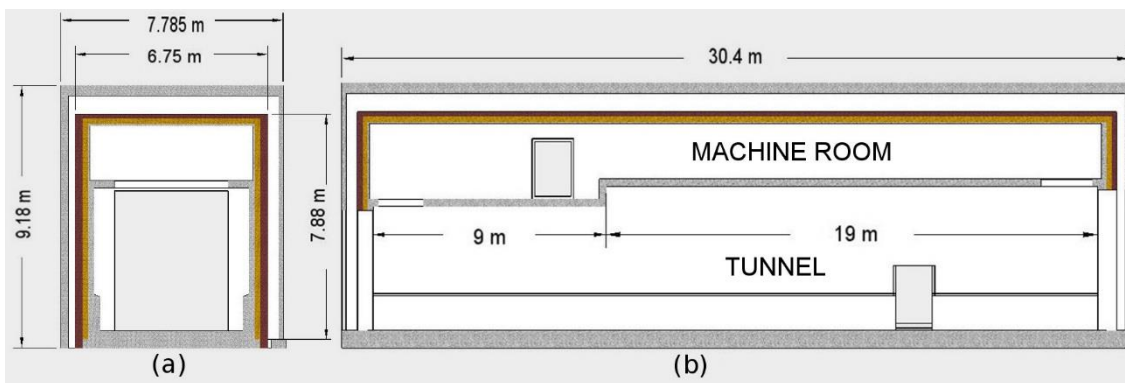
ATP test station (a) sezione trasversale (b) sezione longitudinale
